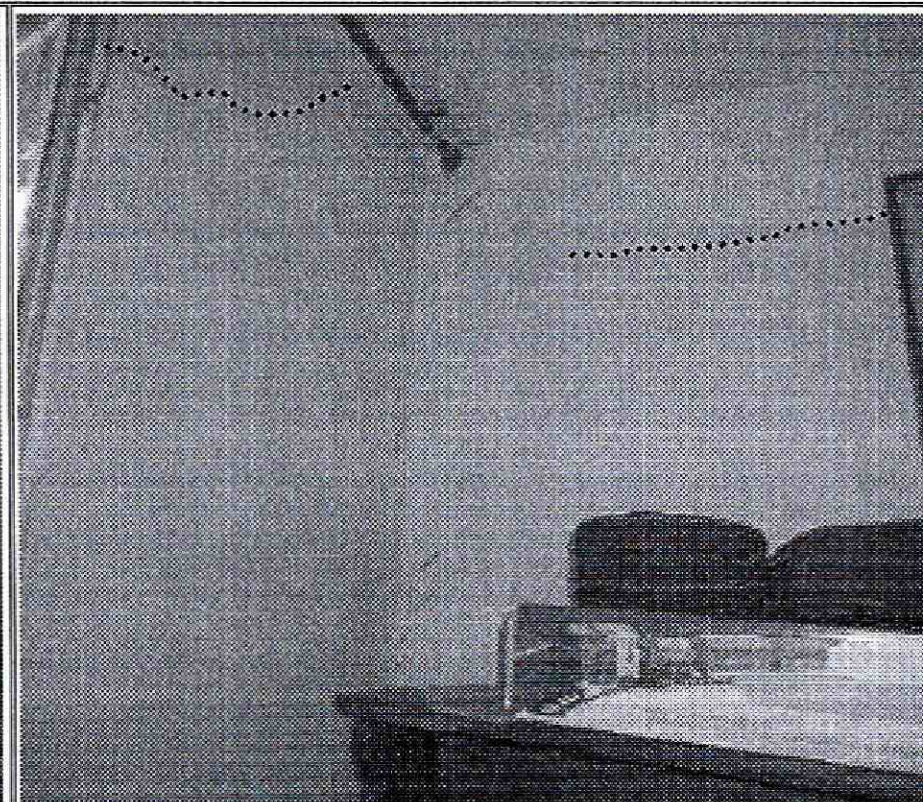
Fisuras tendencia diagonal, vertical y horizontal muro divisorio primer nivel de la vivienda
